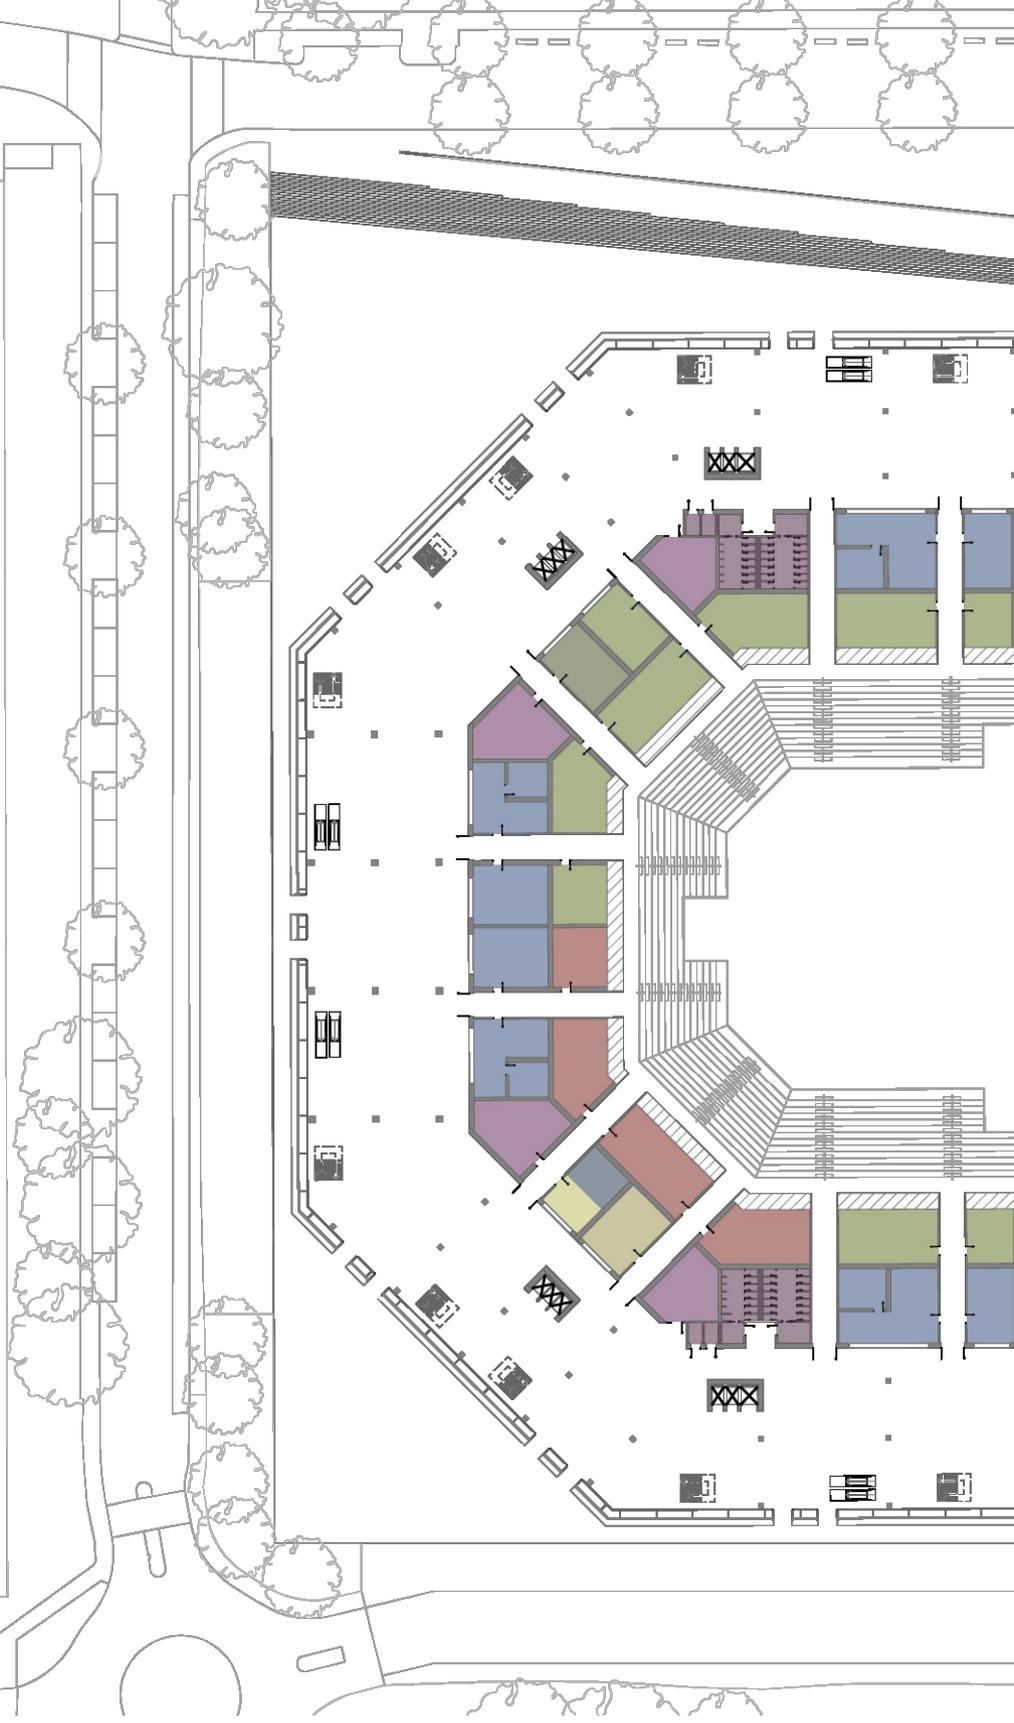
Grundriss 1. OG Nutzungsverteilung
